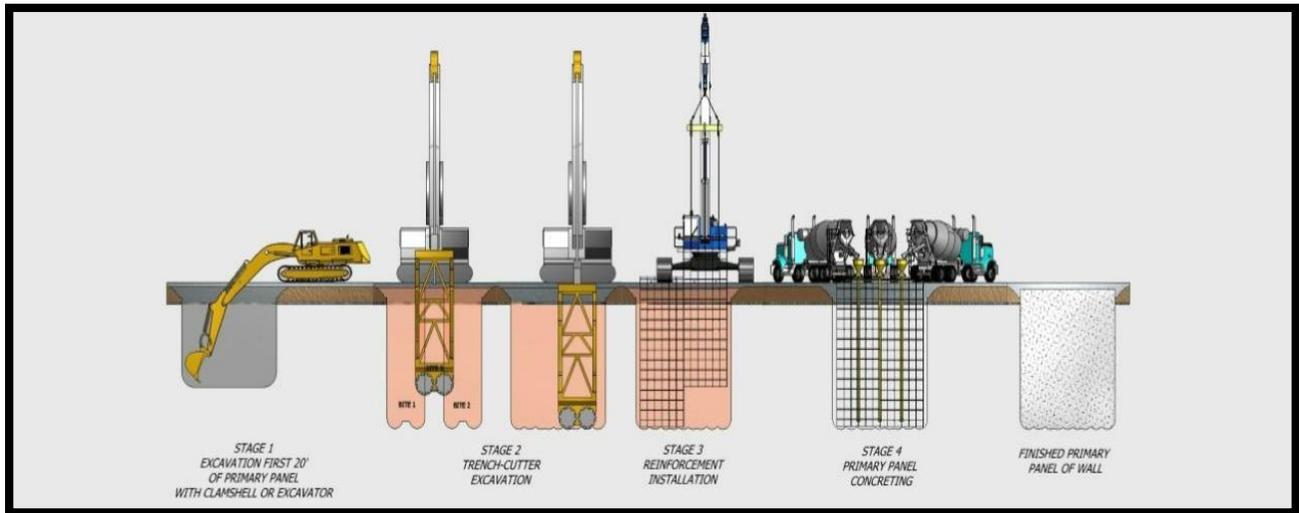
technique paroi moulée. (Advanced construction techniques.com)
